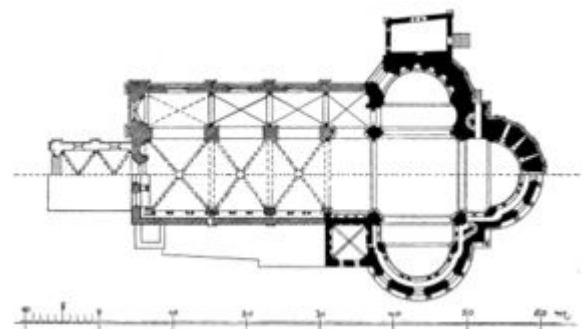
Kirche Gross St. Martin, Grundriss.
